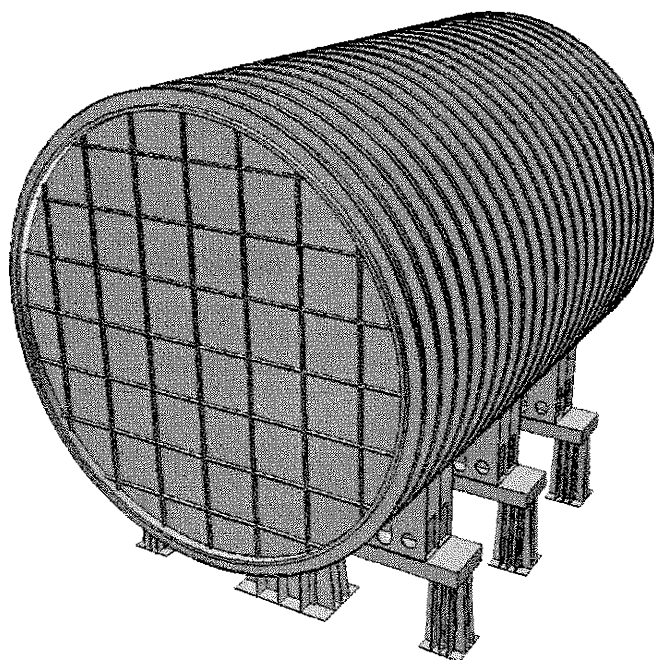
Постановка блока РО на трёх опорных фундаментах с облегченными балками
